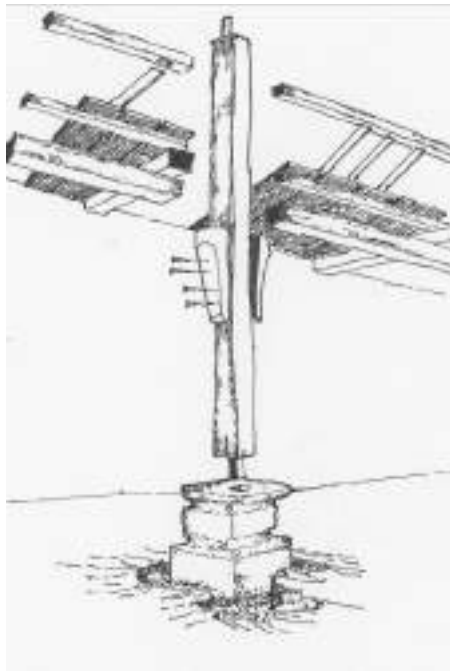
Cañar, Honorato Vázquez. Sistema de ensamblaje y reforzamiento de áreas de apoyo con diseño en piedra basa en portal exterior.
